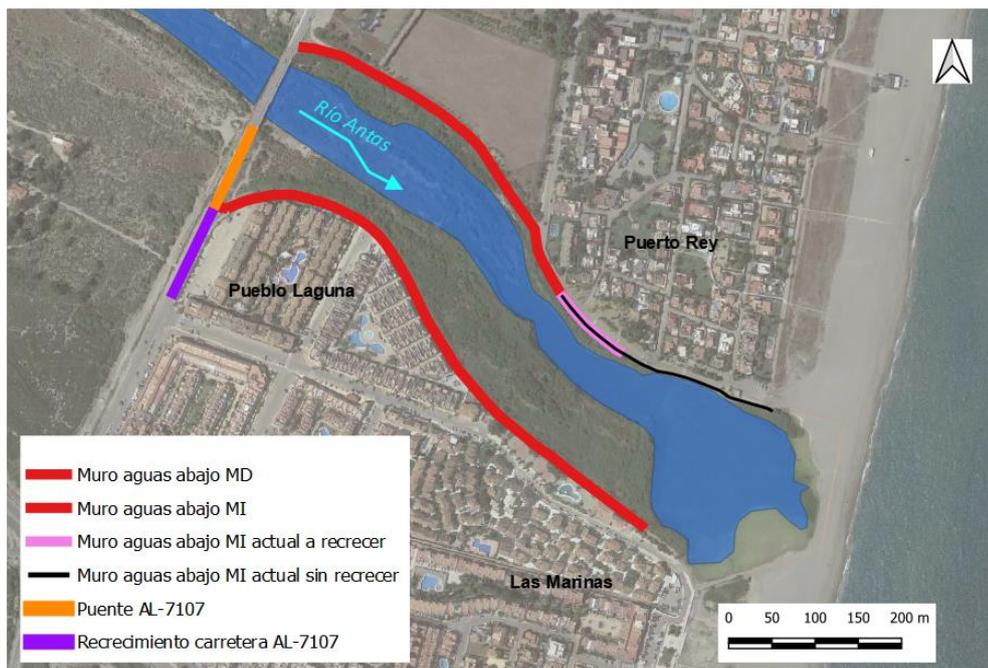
Muros de protección aguas abajo del puente de la AL-7107. Trazado en planta
